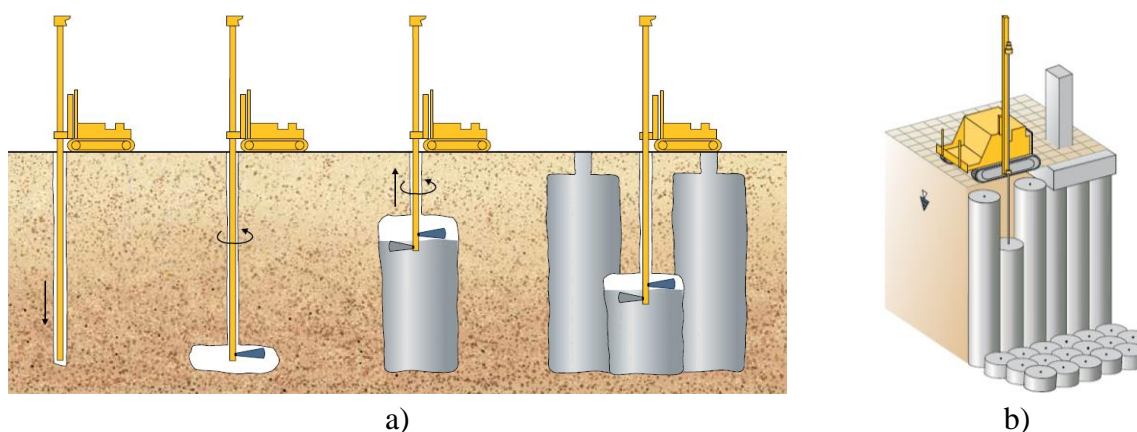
Aplicação da técnica de jet grouting para execução de pilares (a) e em de lajes (b) (Hayward Baker, 2011)
